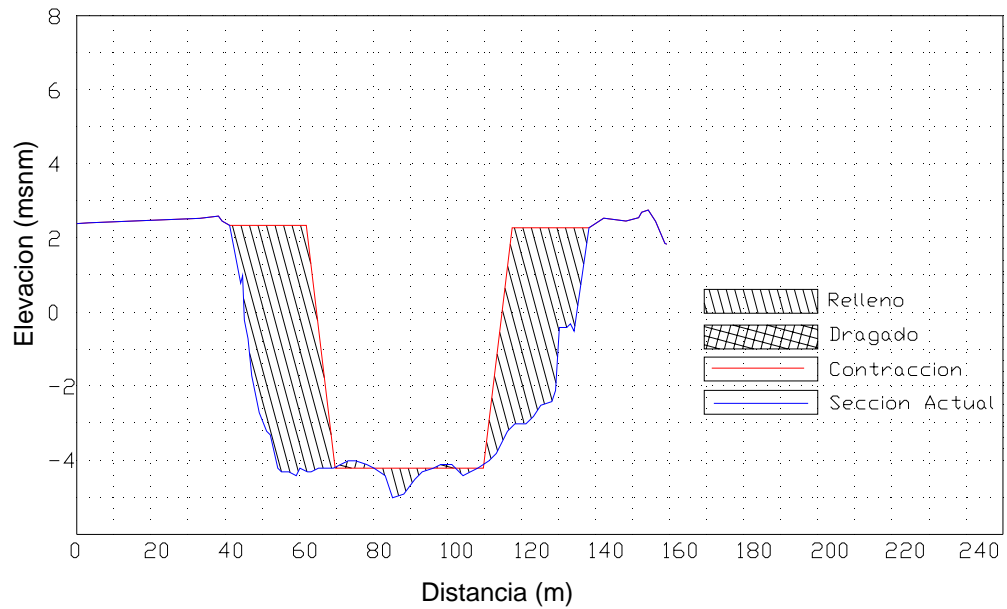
Sección transversal km 74 - Contracción No. 3
